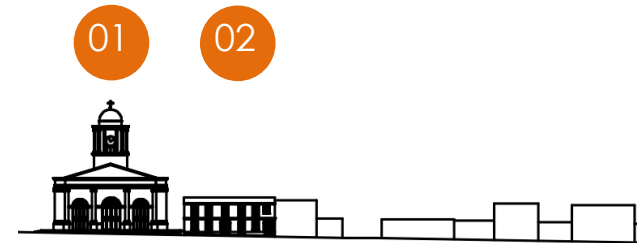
Perfil en Calle 3 (Sector Sur). Edificios de mayor escala.
